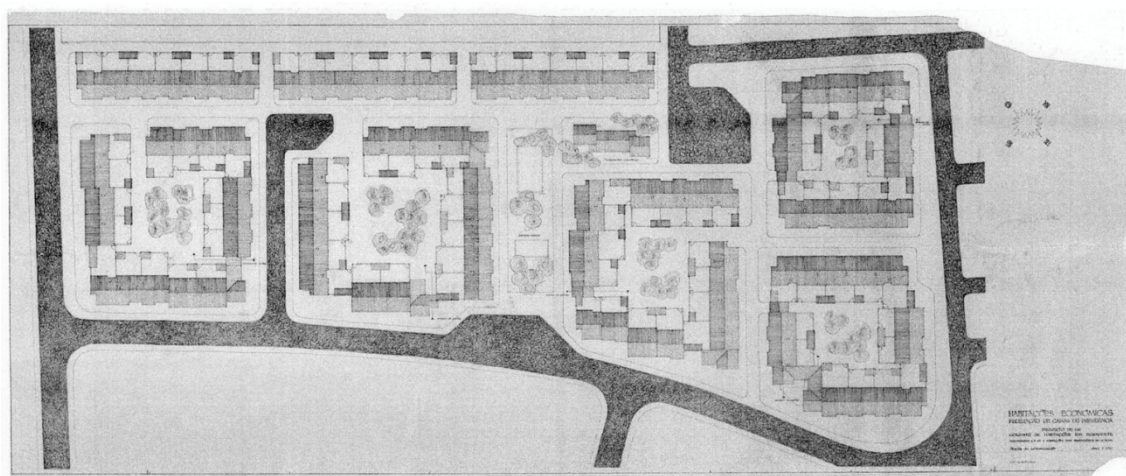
Conjunto habitacional em Benavente (1962) | Vítor Figueiredo e Vasco Lobo | Planta de implantação |
